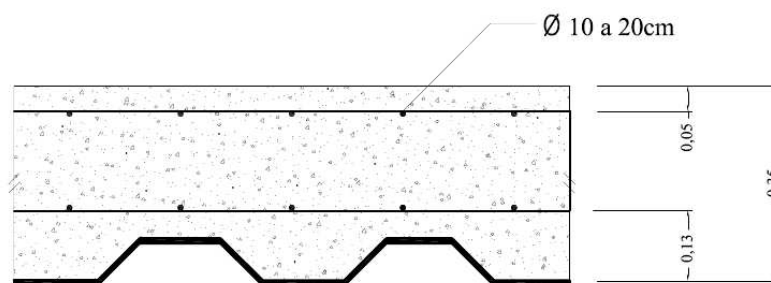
Detalle de sección, armadura y chapa de grecada de losa.
